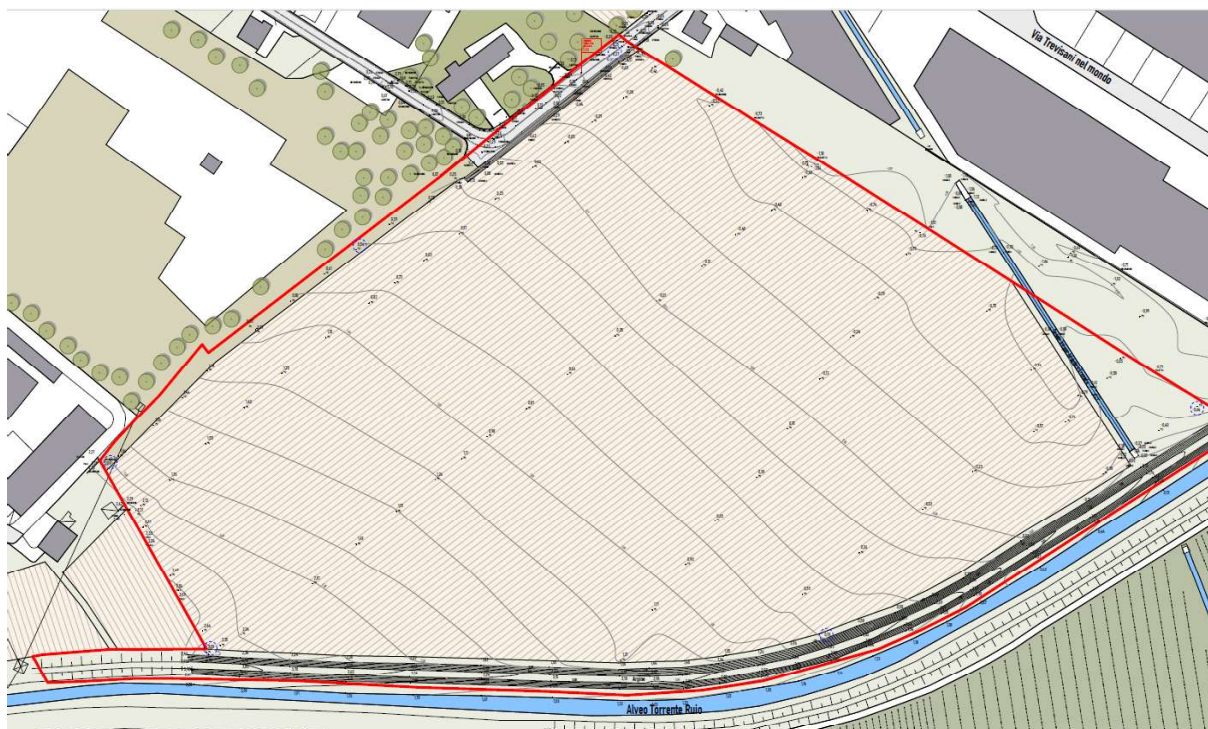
Estratto a scala ridotta della tavola S05 "Planimetria generale con rilievo planoaltimetrico".
